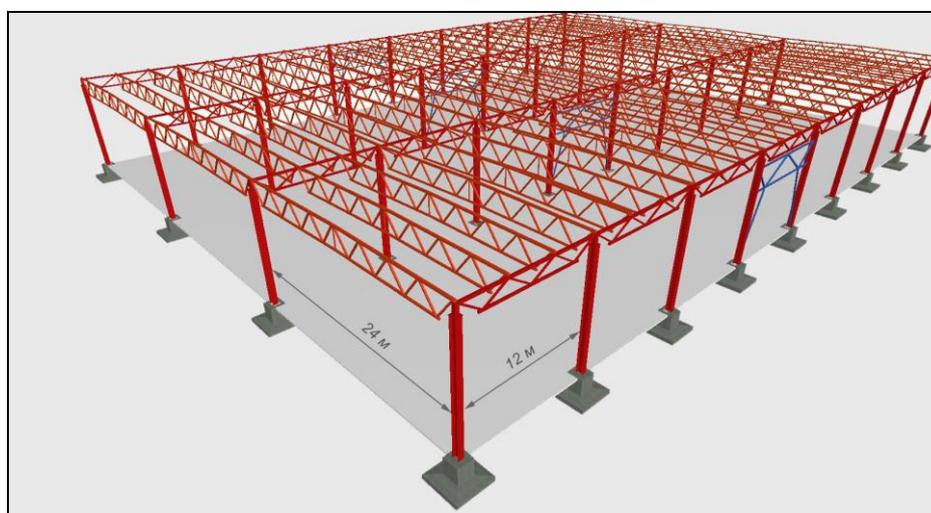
Пример планировки здания пролетом 24 м и шагом колонн 12 м
